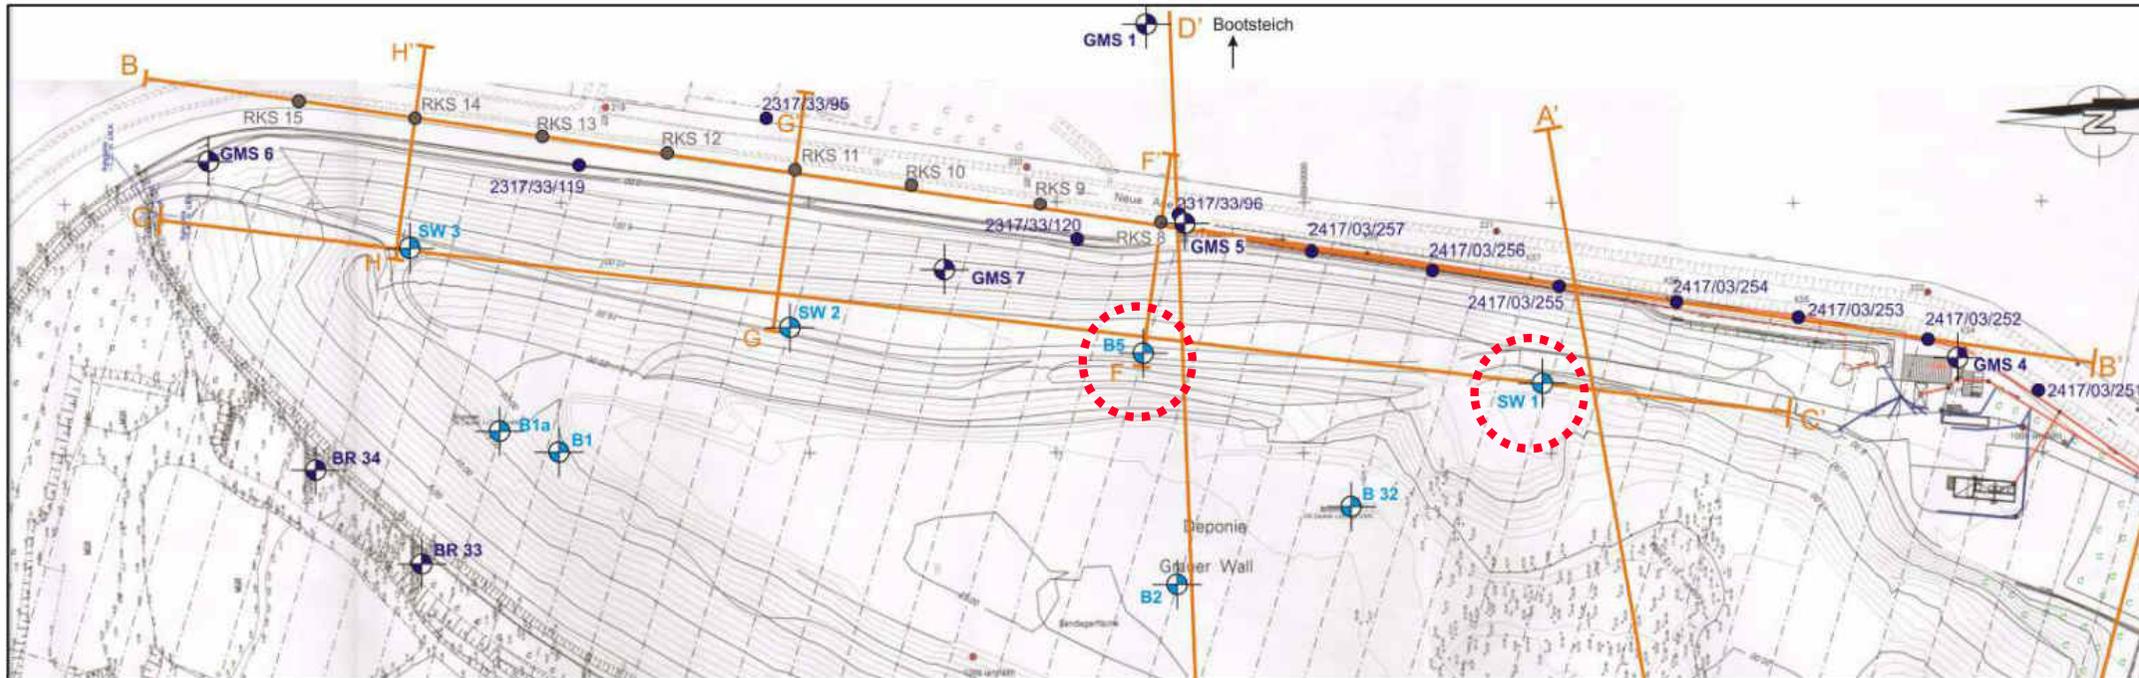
Ausschnitt Lageplan Untergundaufschlüsse (aus [U5])
